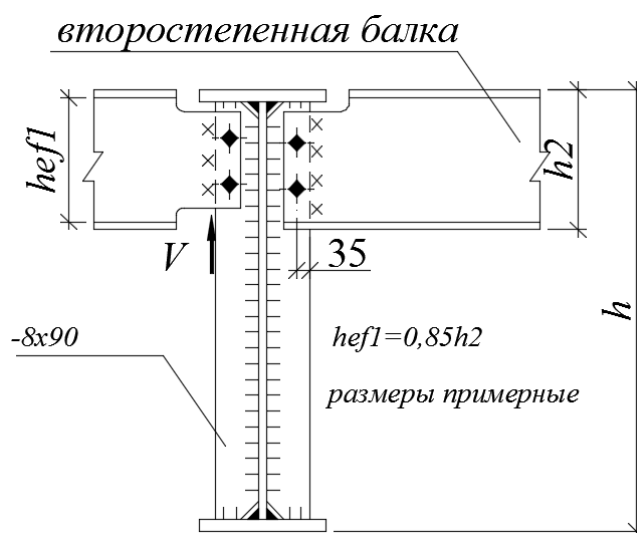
Сопряжение второстепенных балок с главными на сварке
